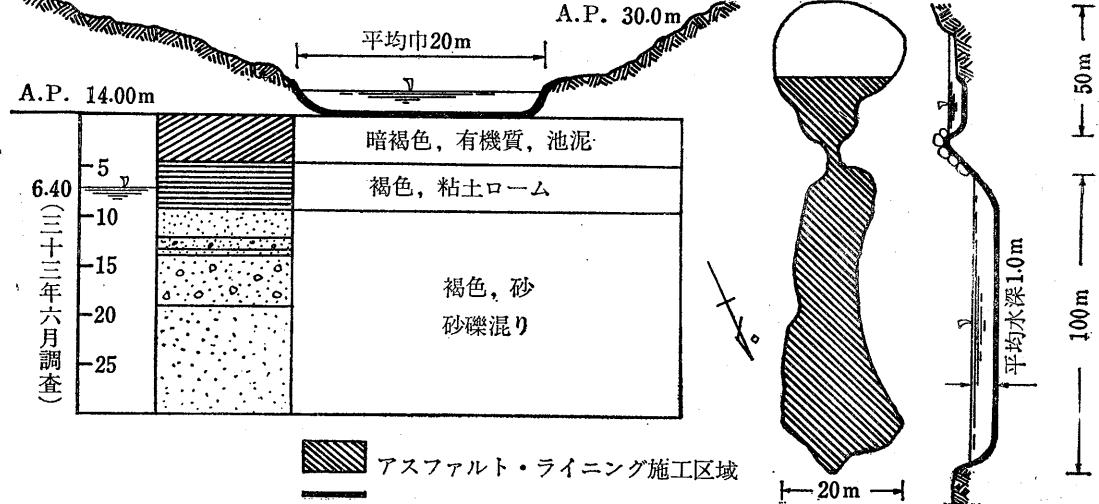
赤坂上池平面図、縦横断面図、土質柱状図
